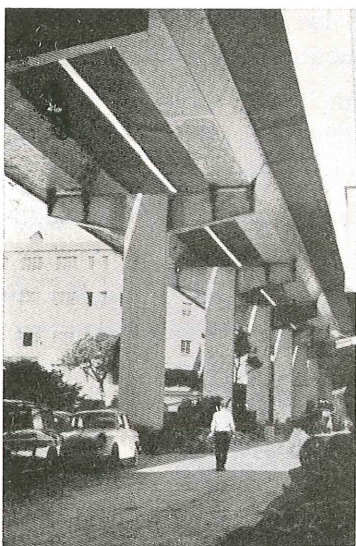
Vía elevada en Génova. Vista general de la obra.
